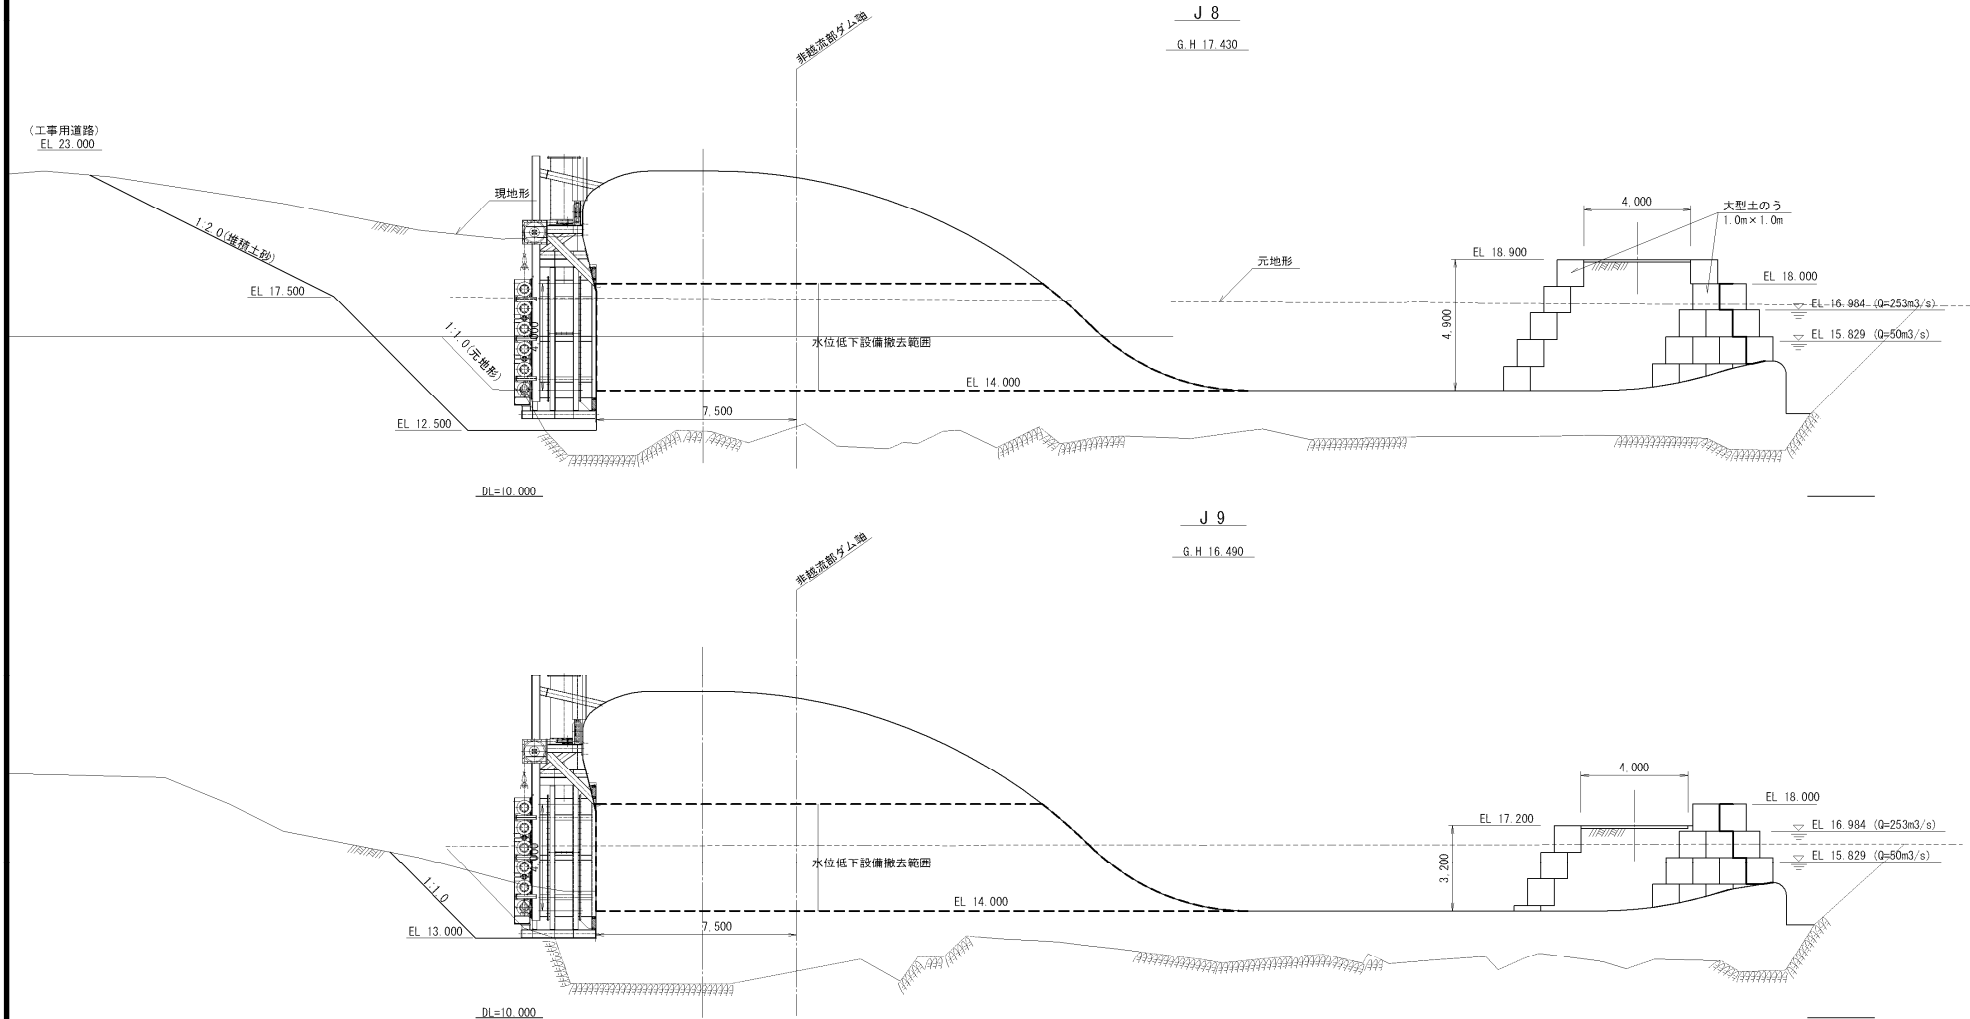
水位低下設備設置に伴う掘削横断面図
